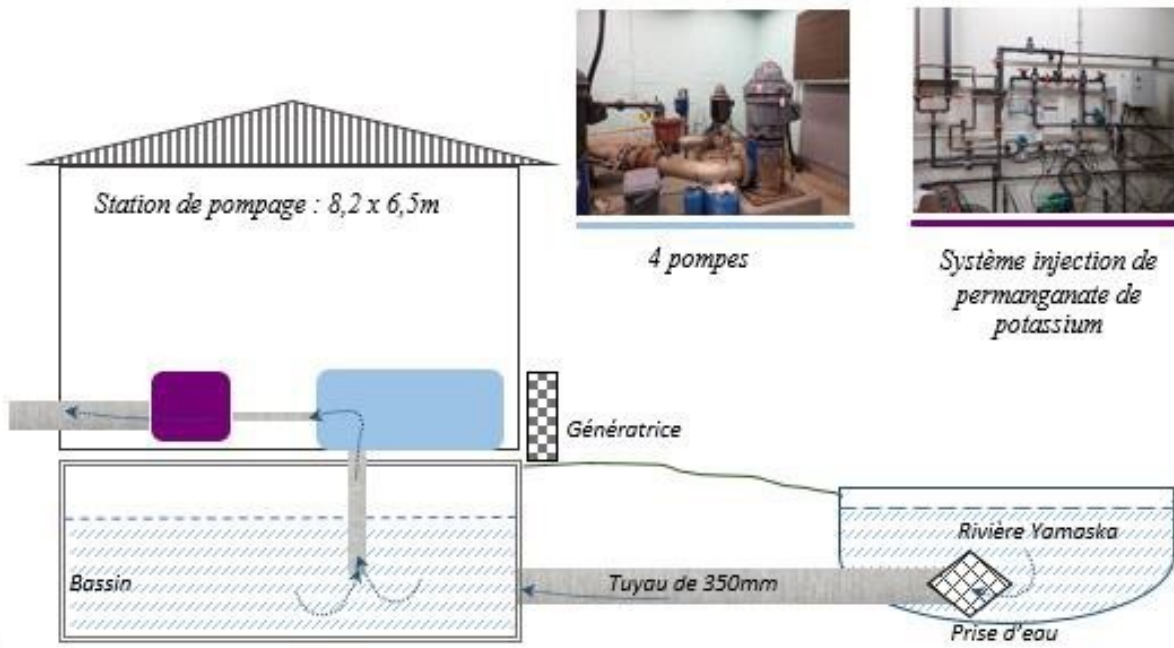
Vue vers le nord, coupe A-A' — Schéma des installations de prélèvement d'eau potable
